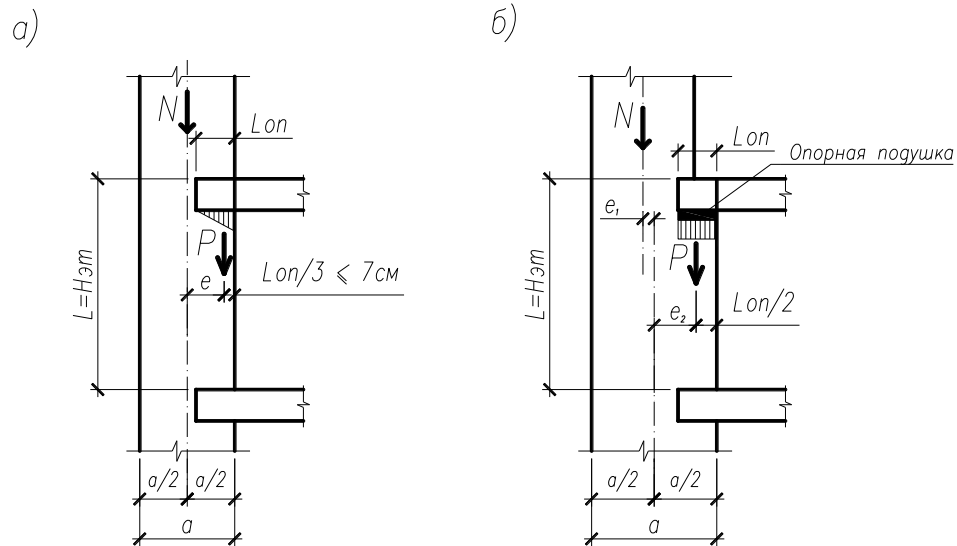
Расчетная схема стены здания с жесткой конструктивной схемой
